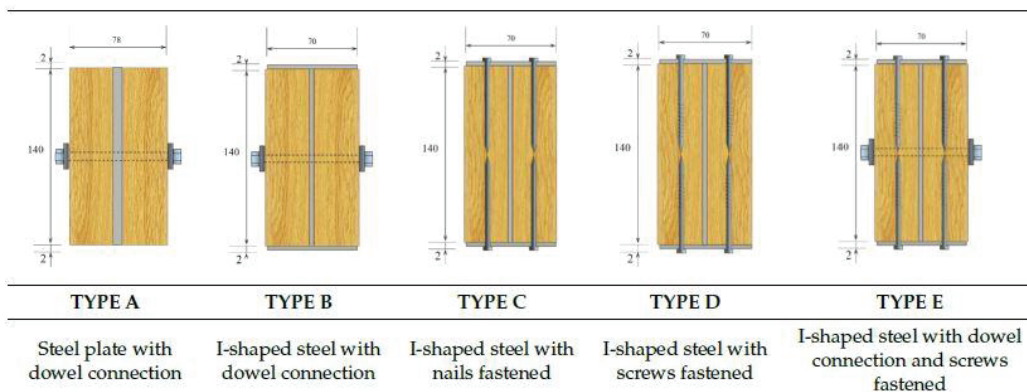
Section des poutres hybrides testées [TSA 2018]
